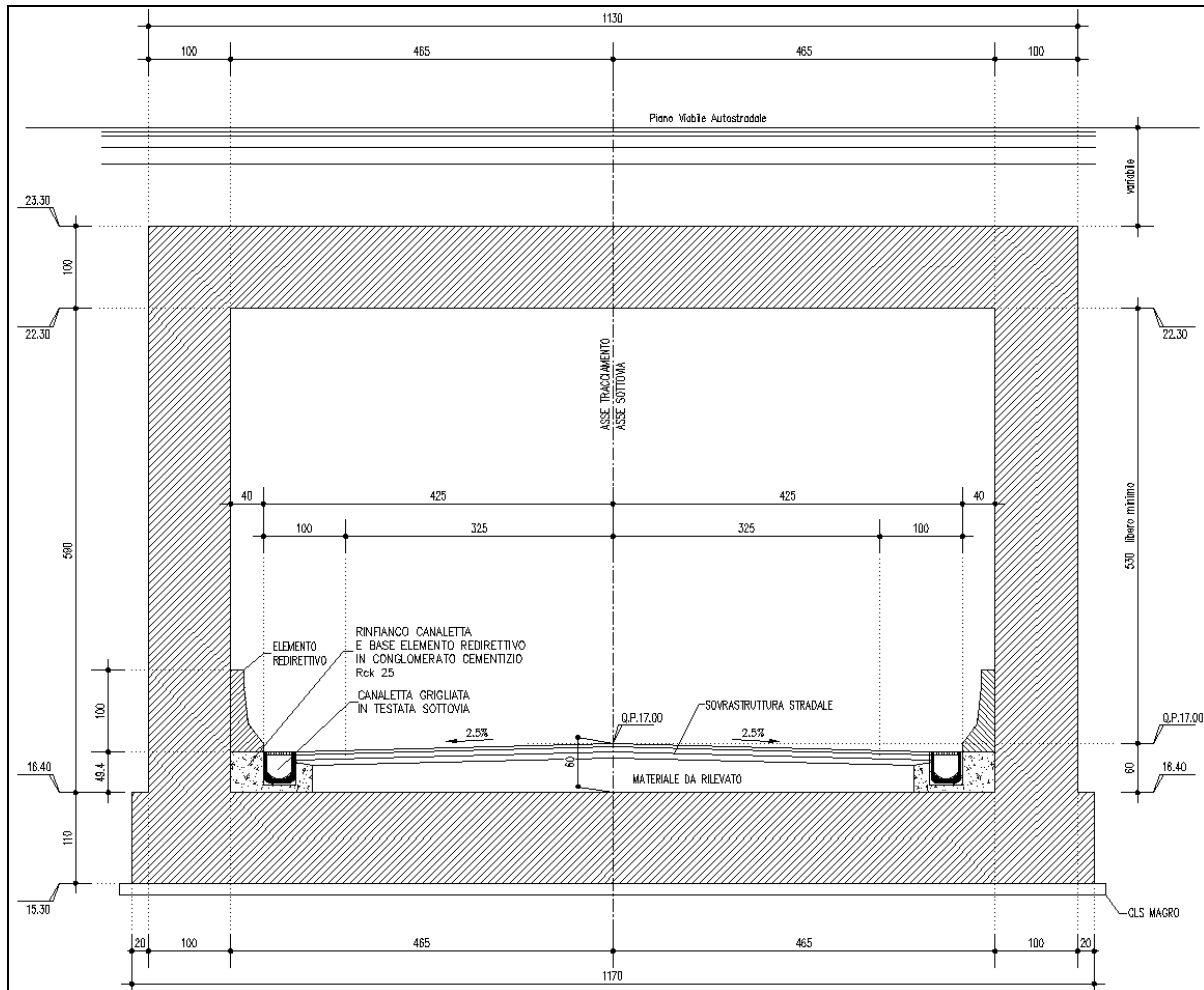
SEZIONE TRASVERSALE DEL SOTTOVIA
